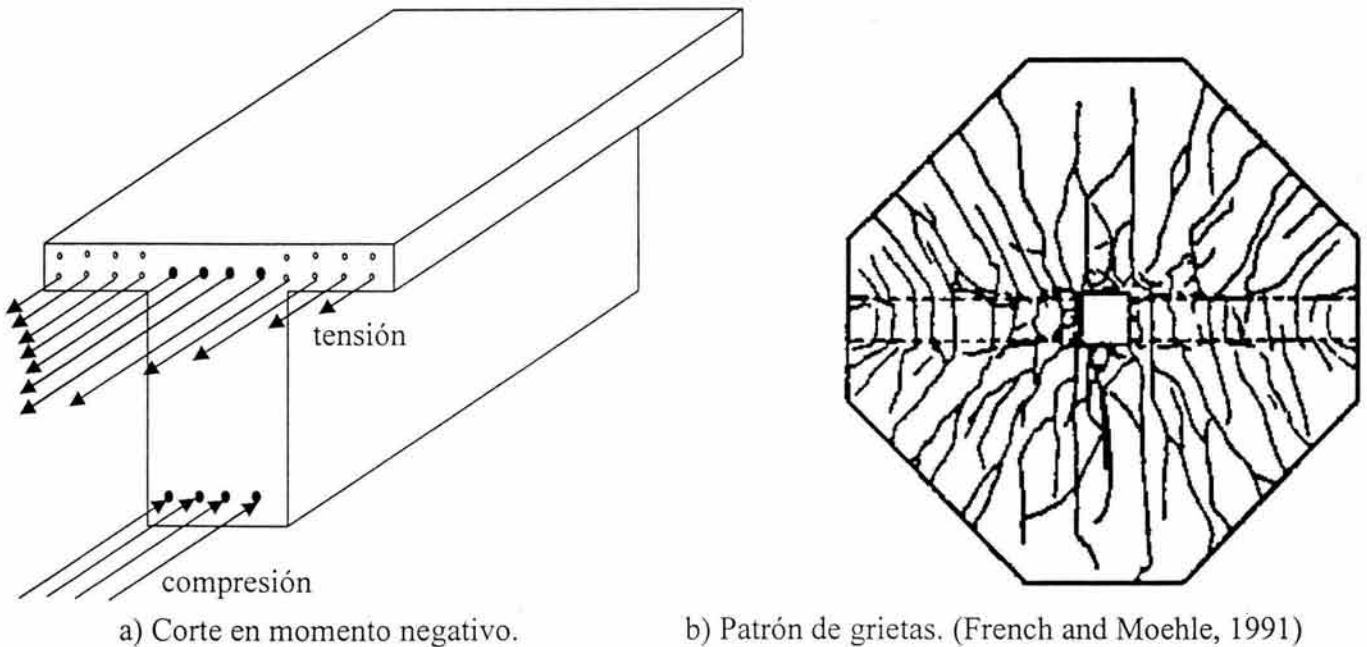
Corte transversal de una viga considerando parte de la losa.
